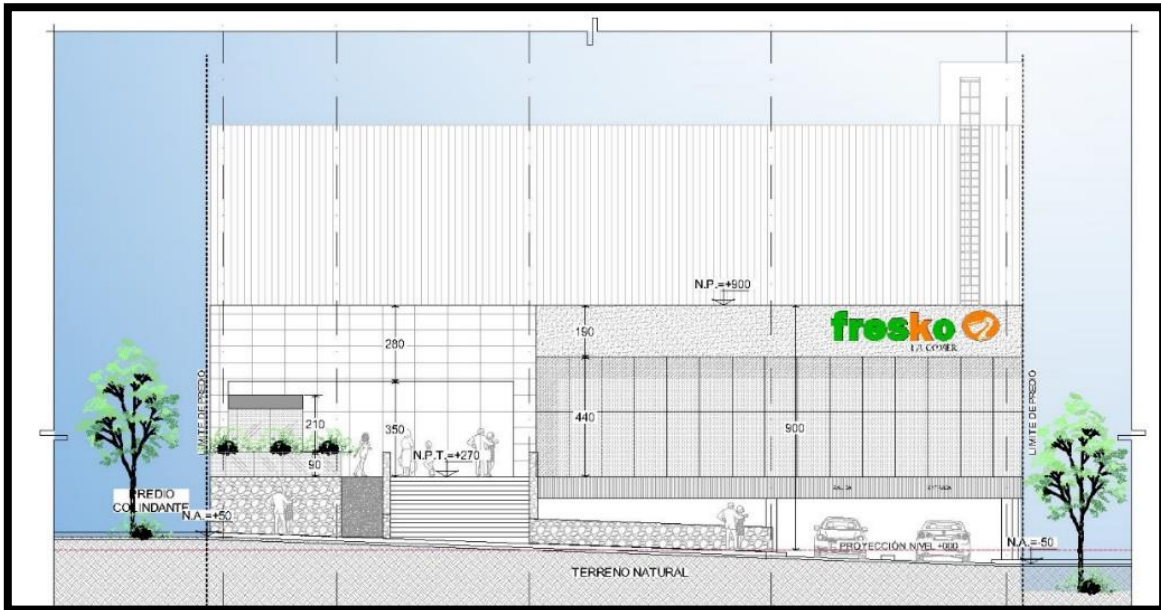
Fachada del Centro Comercial sobre Av. Del Carmen.
